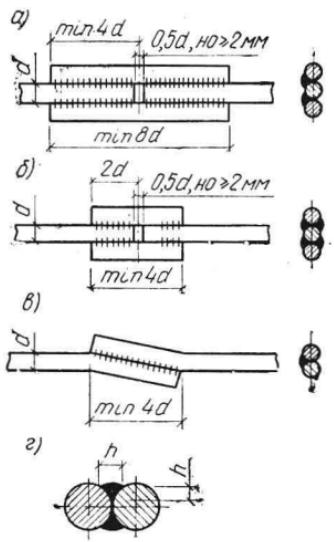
Стыки стержней из горячекатаной стали гладкого профиля диаметром до 32 мм, выполняемые дуговой сваркой встык с двумя накладными и одним фланговым швом
